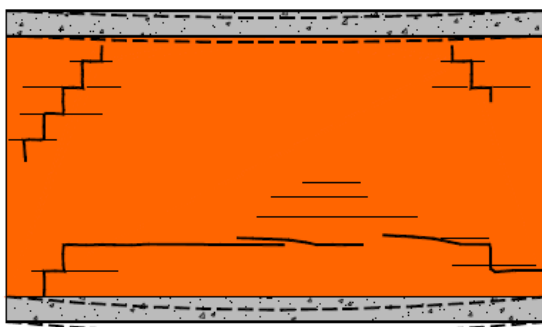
Fissuras provocadas pela deformação do elemento de suporte ser maior que a deformação da viga superior [15]
